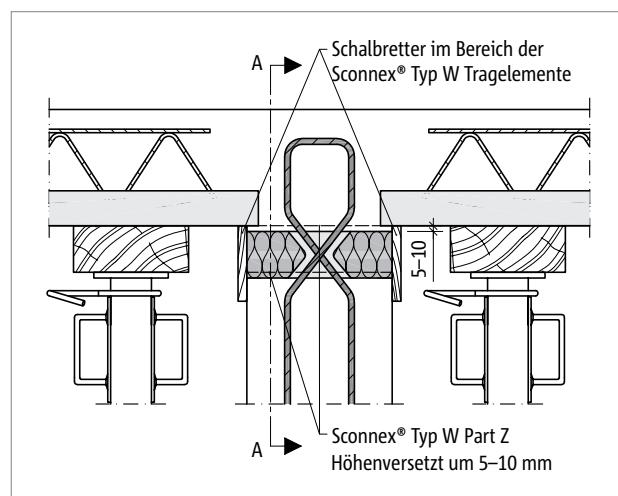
Schöck Sconnex® Typ W: Schematische Darstellung (Einbauzustand) Schöck Sconnex® Typ W bei Halbfertigteildecken und Unterdeckendämmung
